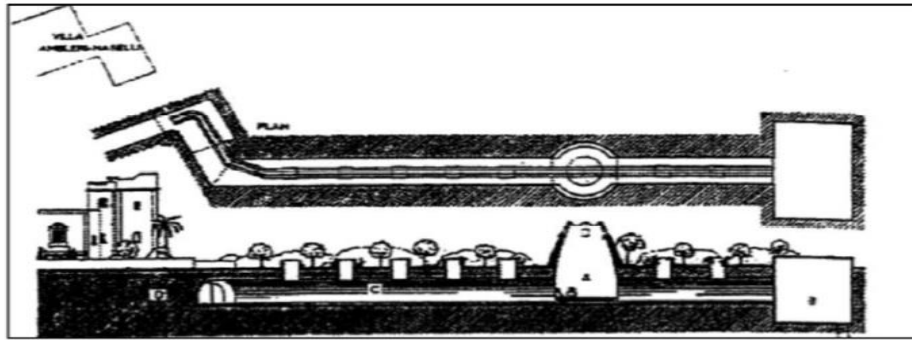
Plan et section du système de refroidissement souterrain de la villa Ableri-Nasseli[2]
